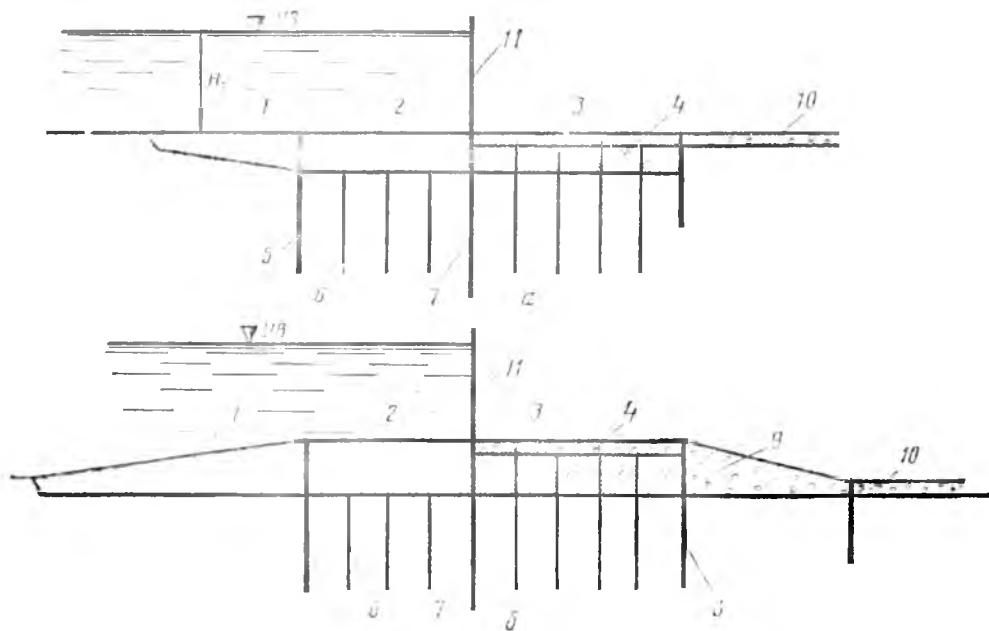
Схемы свайных флюбетов деревянных плотин:
